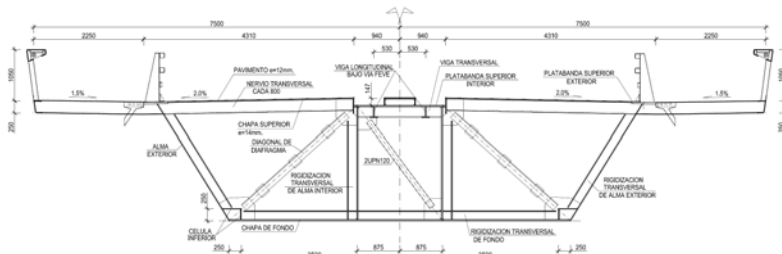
Puente basculante de Santander. Sección transversal tipo
